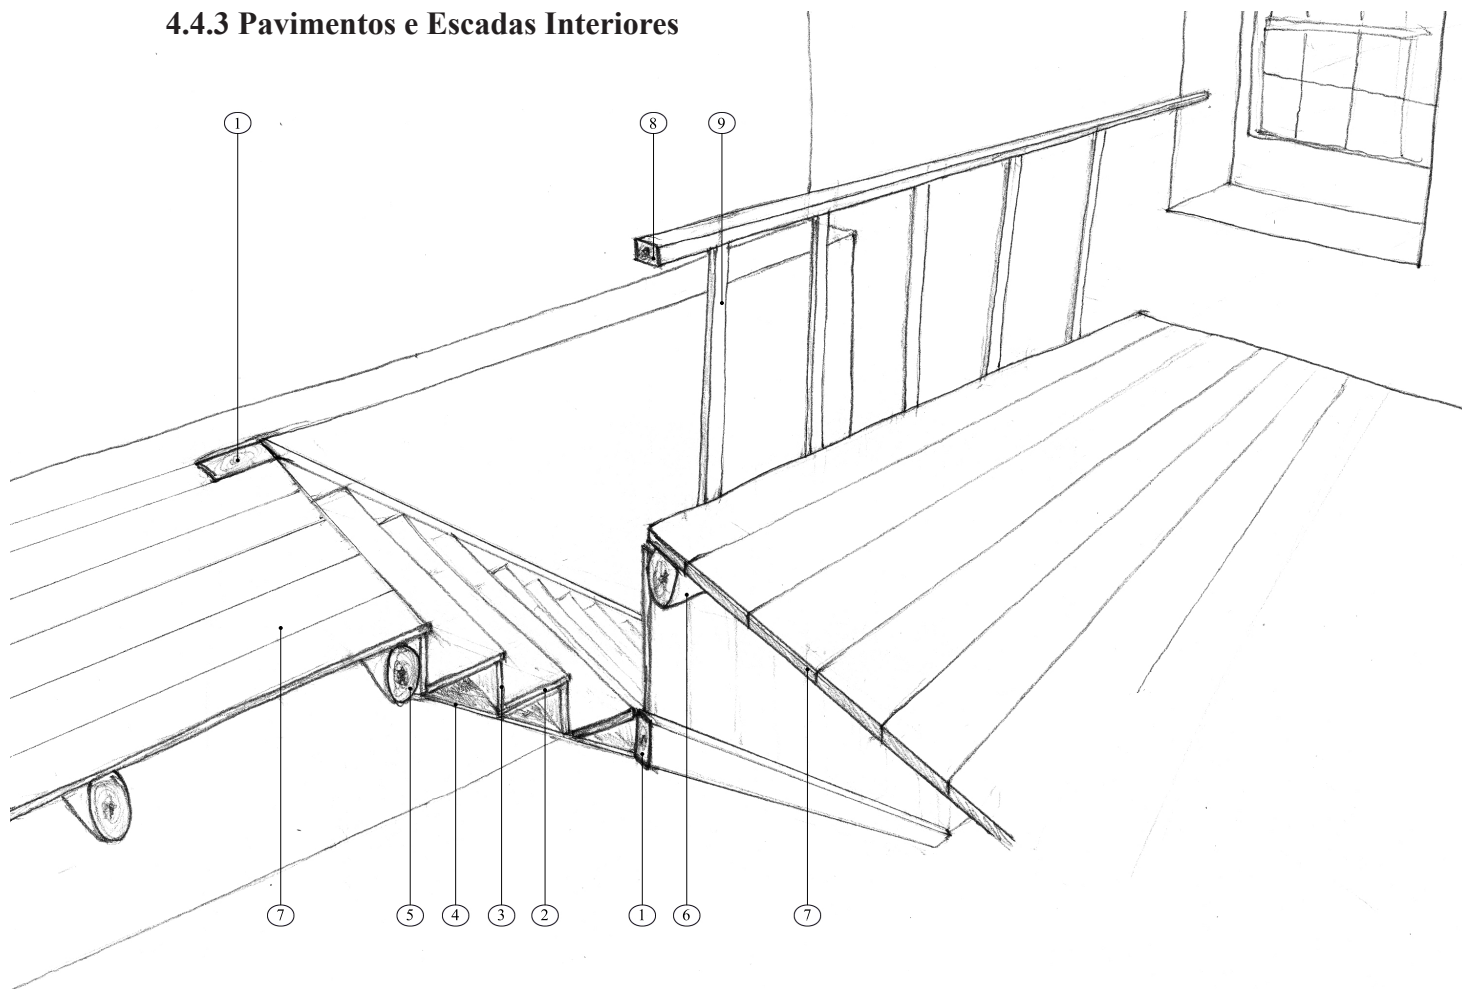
Pormenor escadas interiores, de um lanço, em madeira. Legenda: 1 Perna, 2 Cobertor, 3 Espelho, 4 Tábua de forro, 5 Viga do sobrado, 6 Cadeira, 7 Soalho em madeira, 8 Corrimão em madeira, 9 Prumo guarda-corpos.
